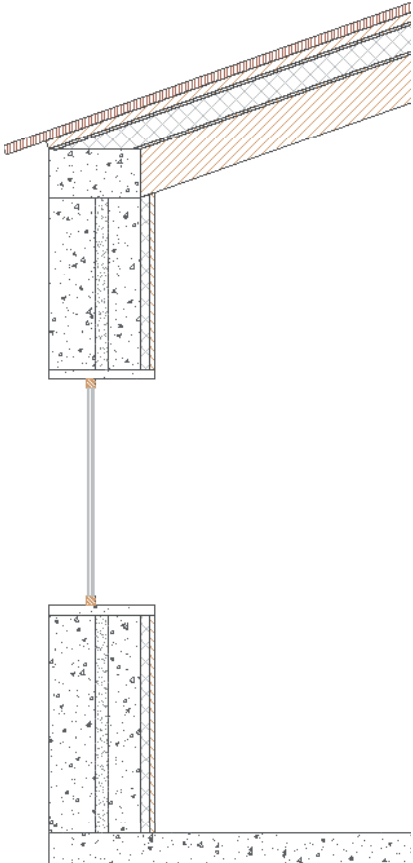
Detalle constructivo edificio rehabilitado. HTFLUX
